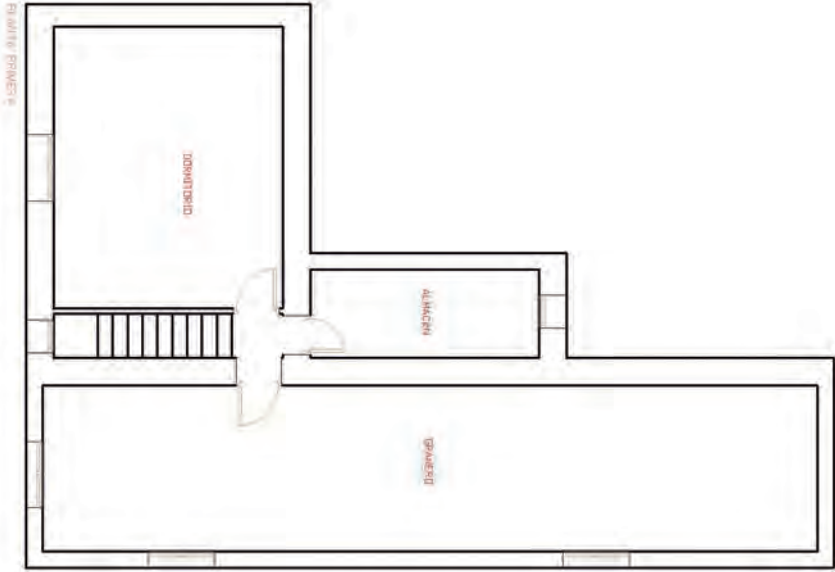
Plano Tipo. Casa-1 Planta primera. Elaborado por Antonio García Hernández.
